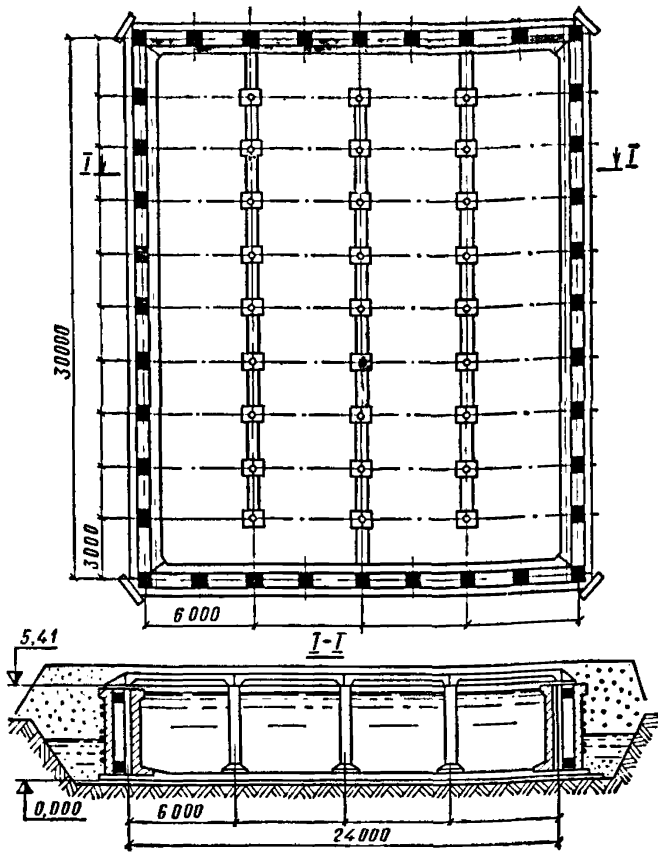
Габаритно-конструктивная схема резервуара типа Б ($V = 3000 \text{ м}^3$)
